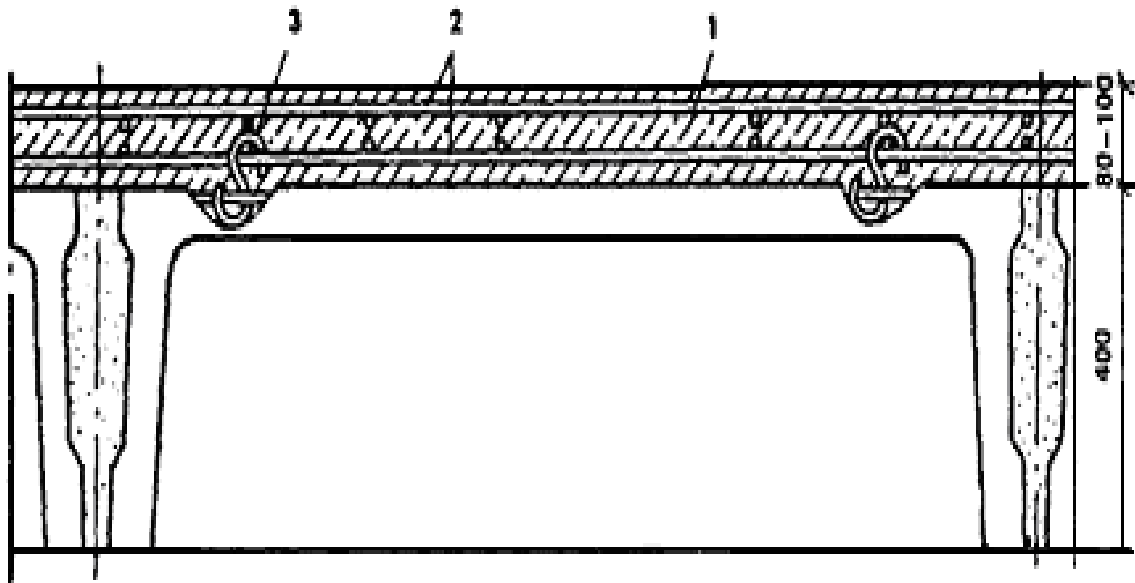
Усиление полки ребристых плит перекрытия монолитной плитой
